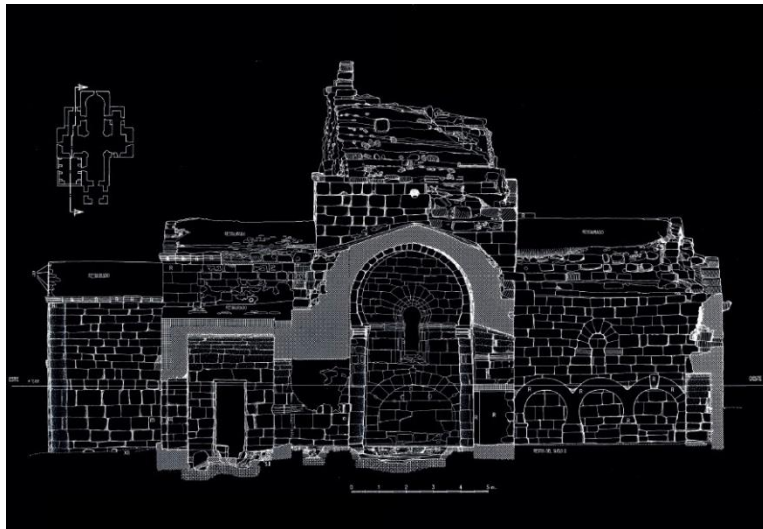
Casalgordo (Toledo). San Pedro de la Mata. Santa María de Melque. Vista general, planta y alzado (según L. Caballero).
